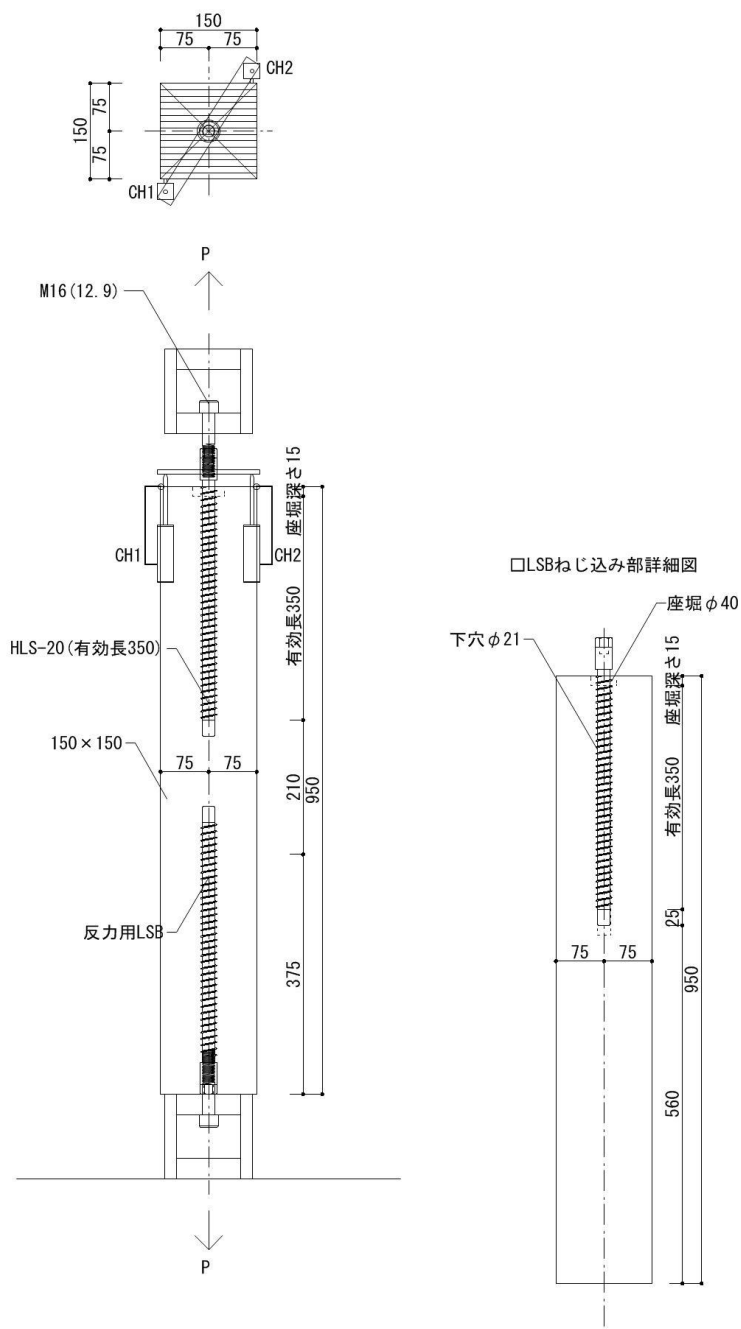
試験体の形状及び寸法 (B-1)
